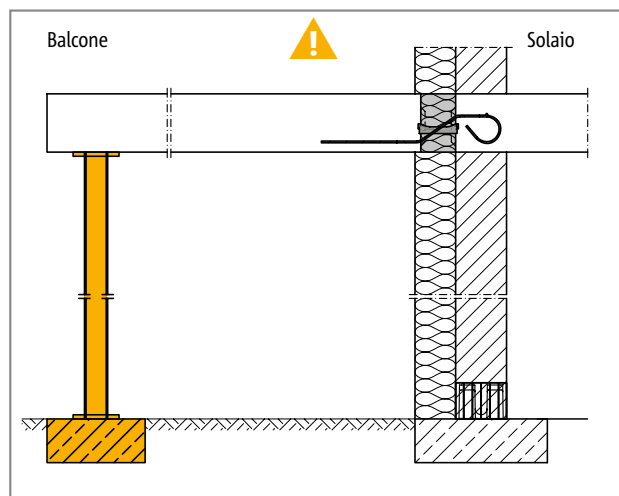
Schöck Isokorb® tipo QXT: è necessario un appoggio continuo
